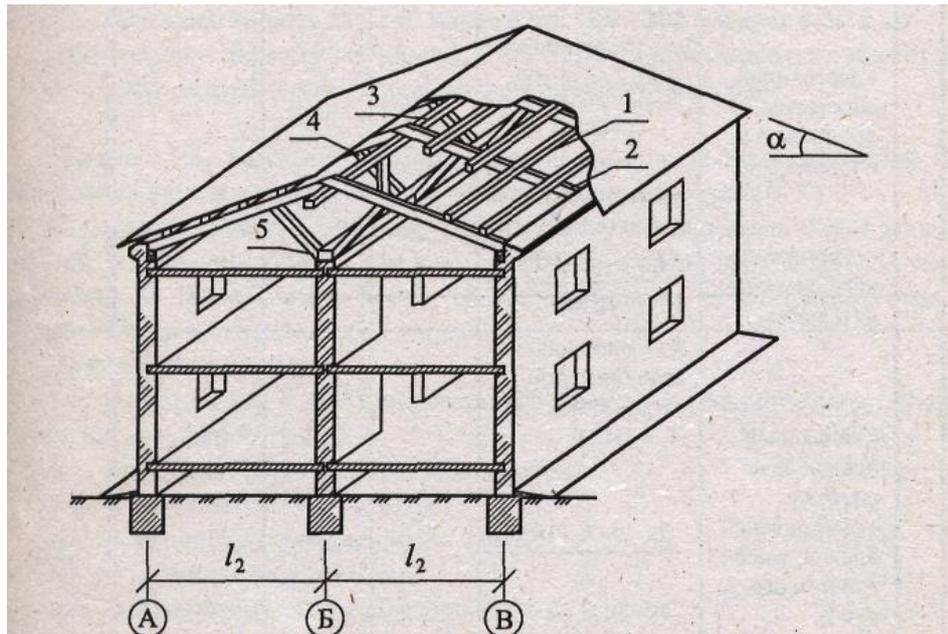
Схема сбора нагрузок от кровли и чердачного перекрытия: 1 - обрешетка, 2 - стропильная нога, 3 - коньковый прогон, 4 - стойка, 5 – лежень.
